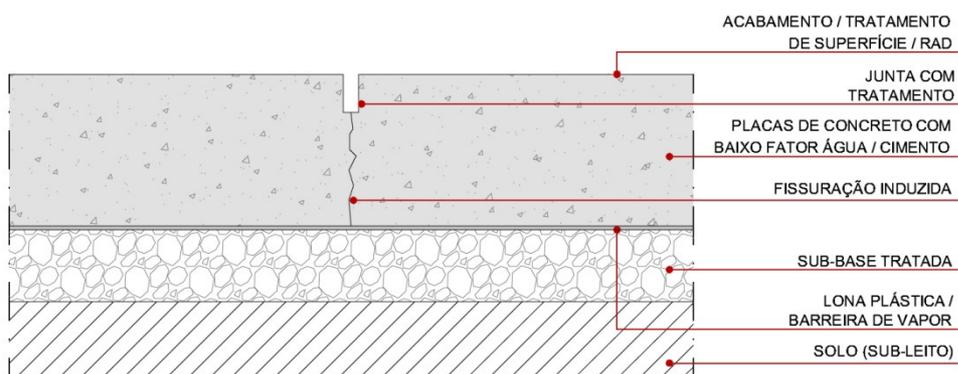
Pavimento de concreto simples sem barra de transferência
